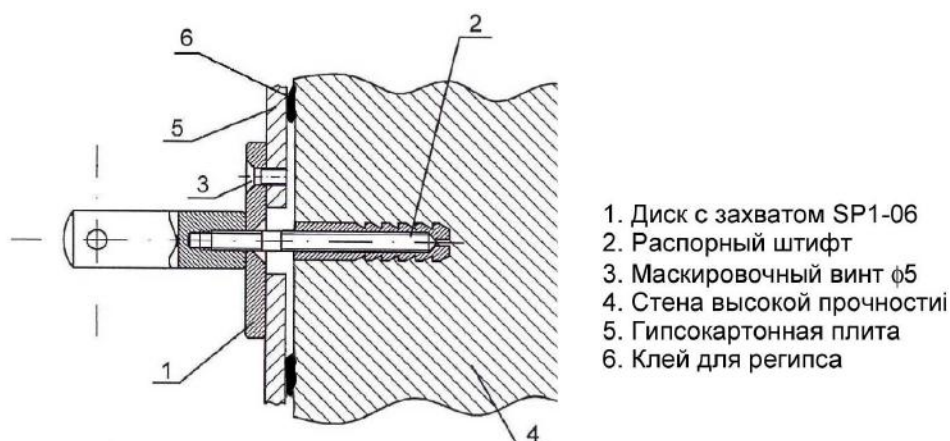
Закрепление диска SP1-06 с помощью «шпильки»
